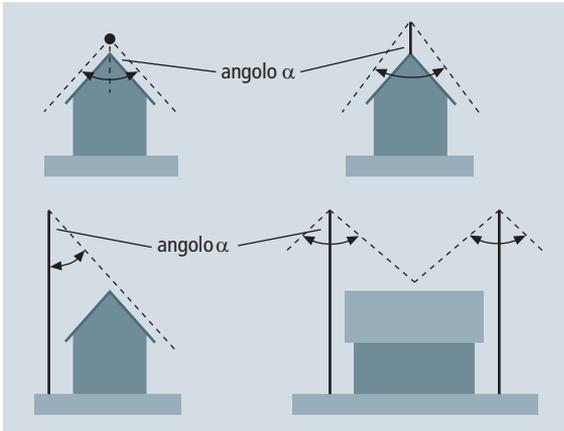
Esempio di impianto di captazione con angolo di protezione α
